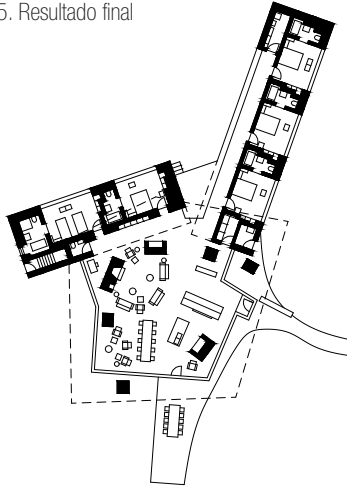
Esquema espacial del refugio secular*, 2025, fuente: elaboración propia basado en planos del autor publicados en Living Architecture, consultado el 4 de julio de 2025, <https://www.living-architecture.co.uk/the-houses/a-secular-retreat/overview/>
